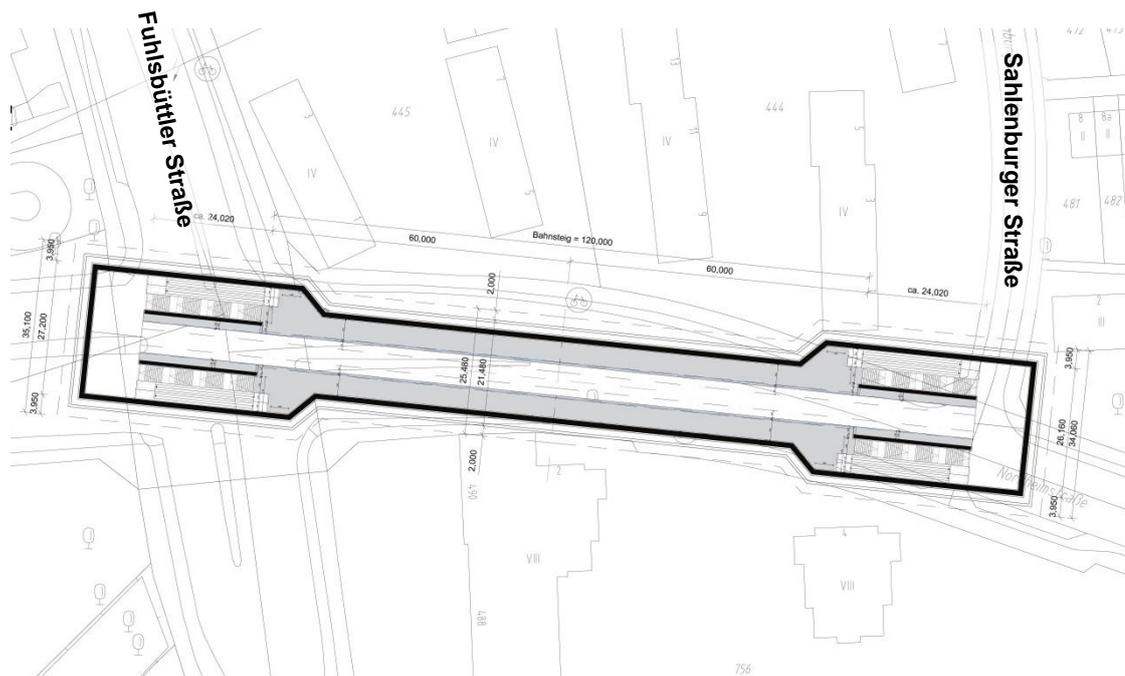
Haltestellenlage Nordheimstraße - Typ A
